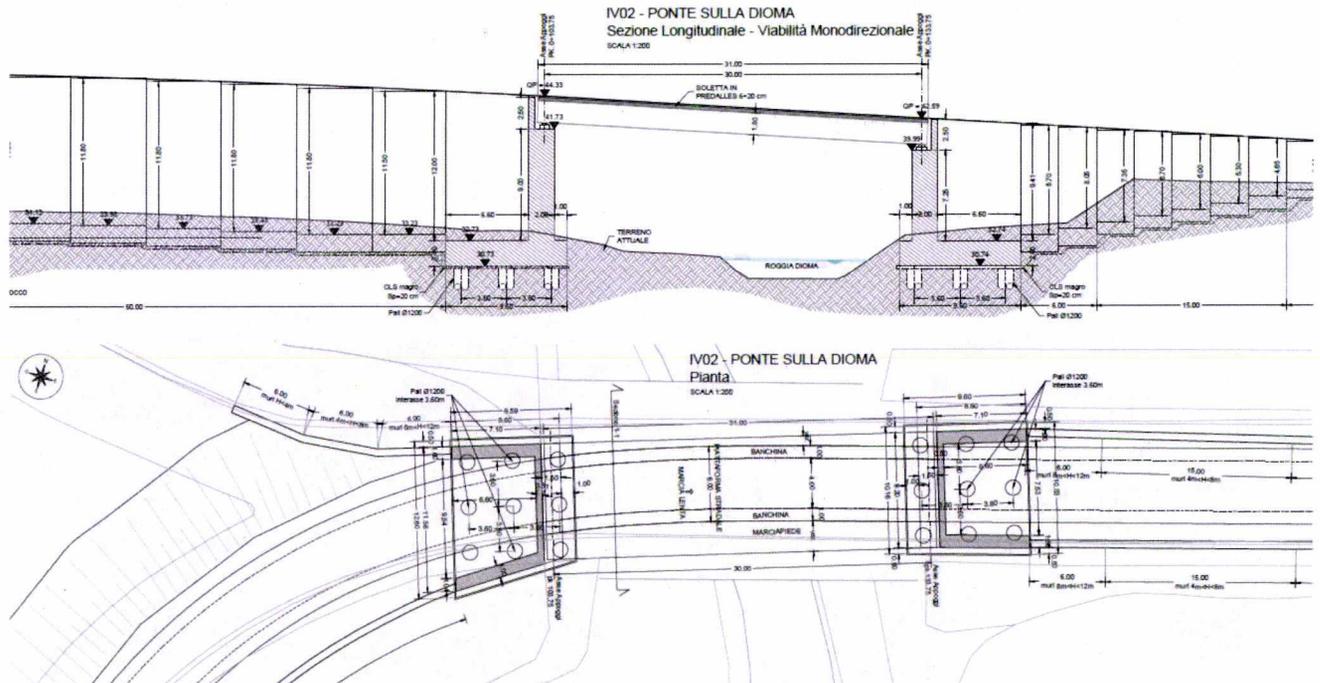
Planimetria e Profilo del Ponte sulla Dioma
